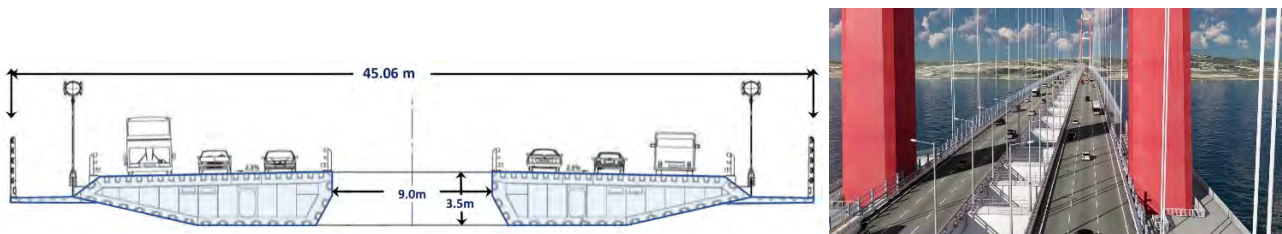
«1915 Çanakkale Bridge<sup>161</sup>» (sezione trasversale e vista impalcato)
